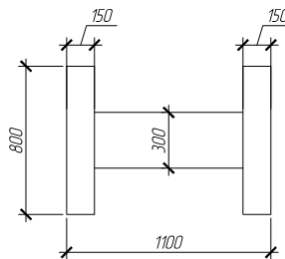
Сечение для расчета продольной арматуры подколонника
